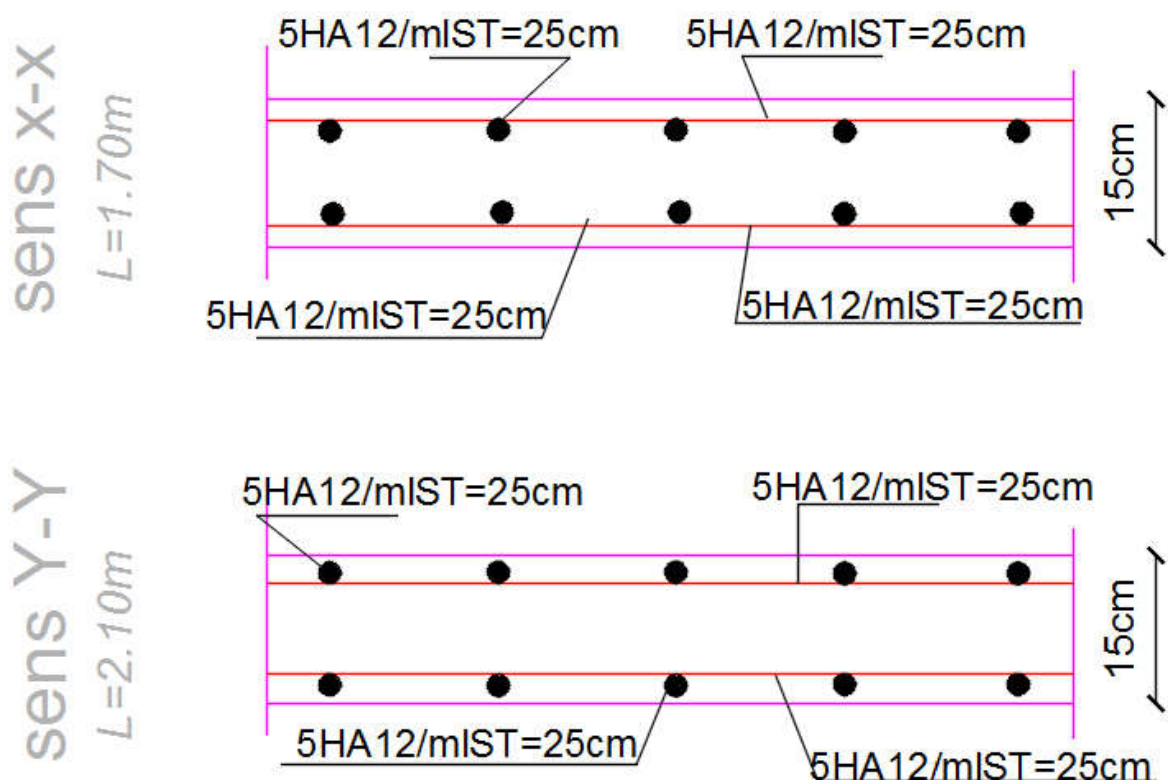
Ferrailage de la dalle plane salle machine.
